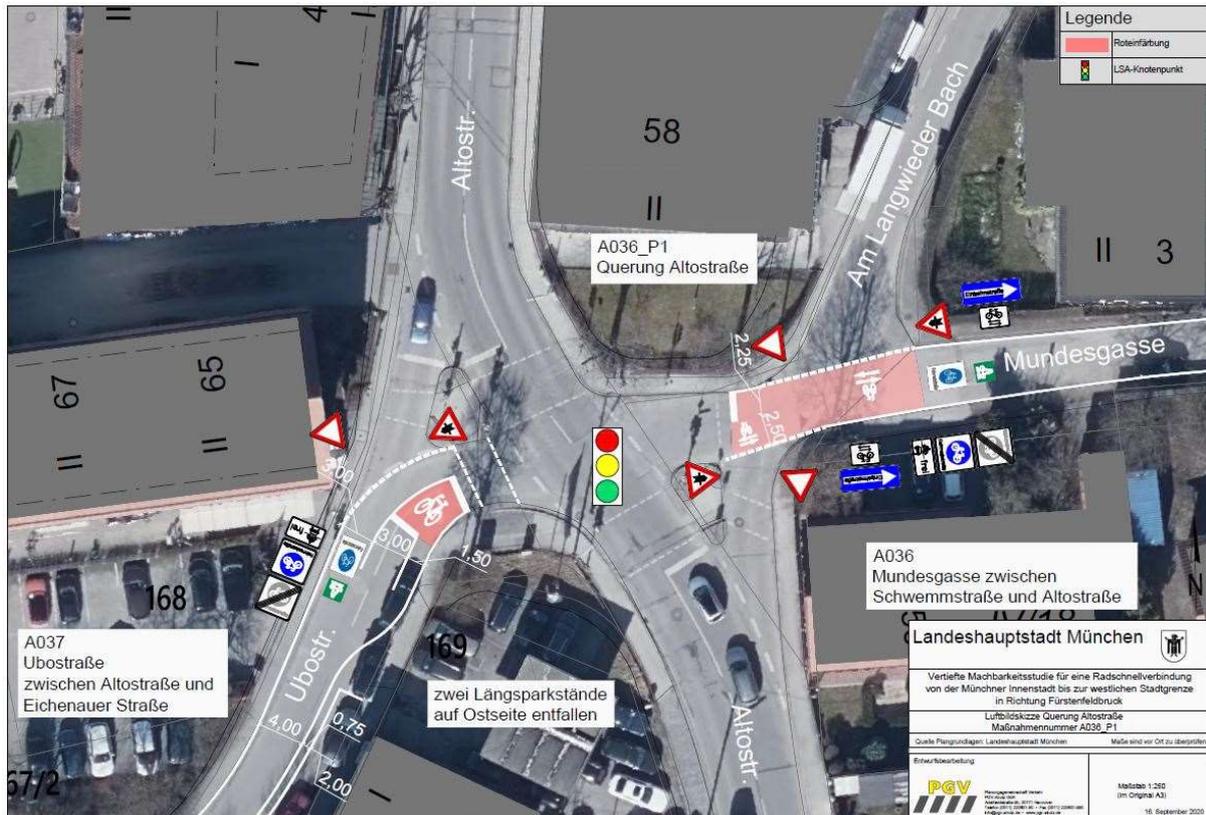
Führung der Radschnellverbindung am Knotenpunkt Altostraße/ Ubostraße/ Mundesgasse (Plangrundlage: Landeshauptstadt München, Detaildarstellung: PGV-Alrutz GbR)
